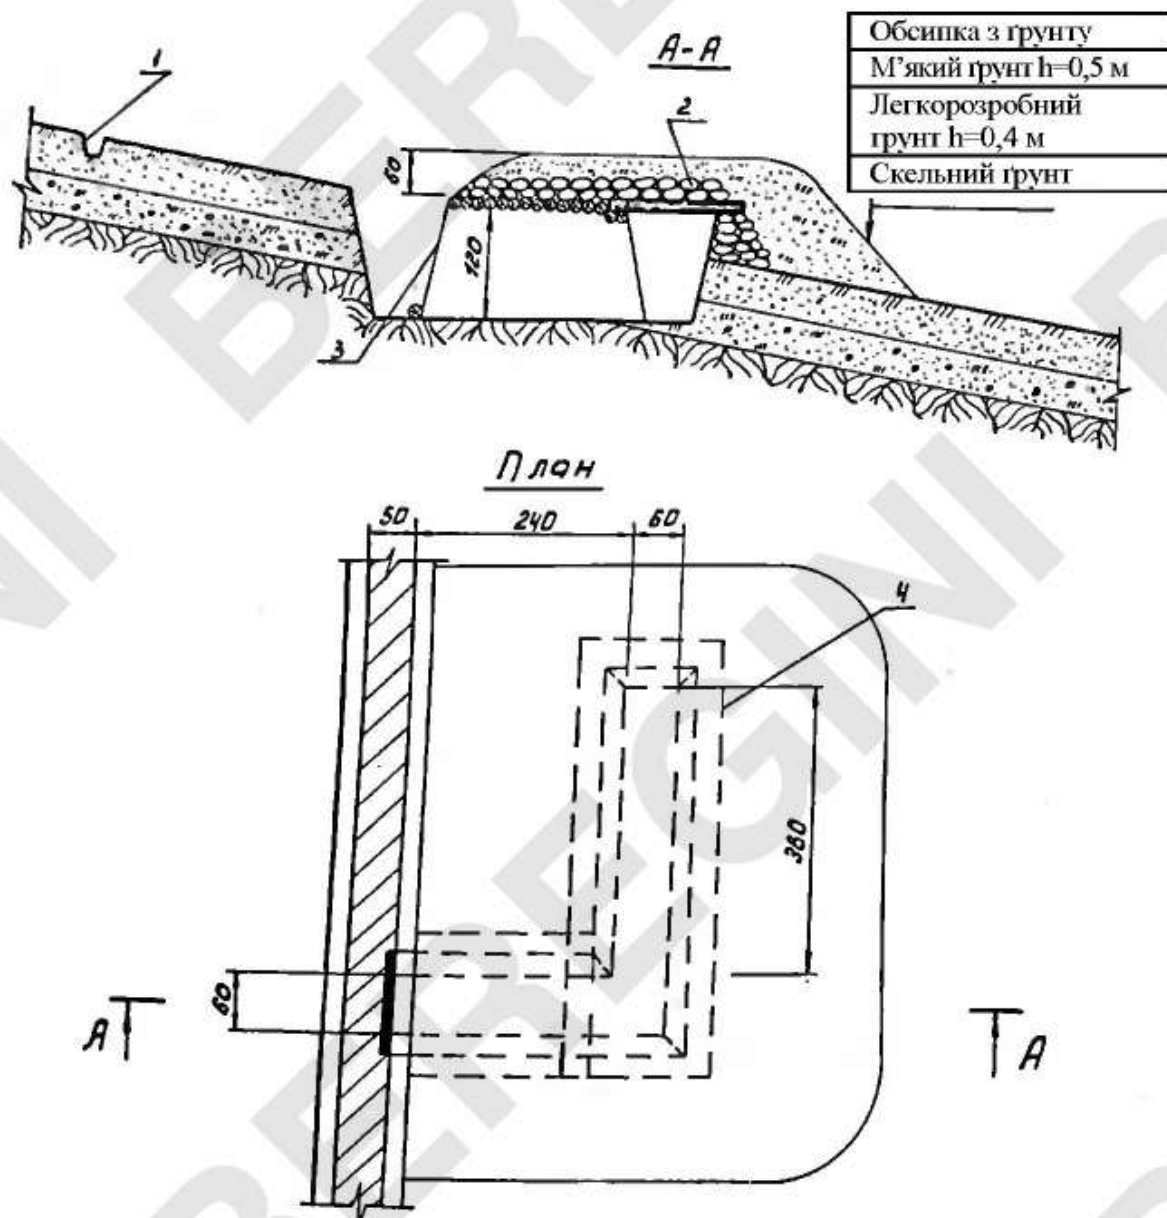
Щілина на відділення з перекриттям із круглого лісу:
